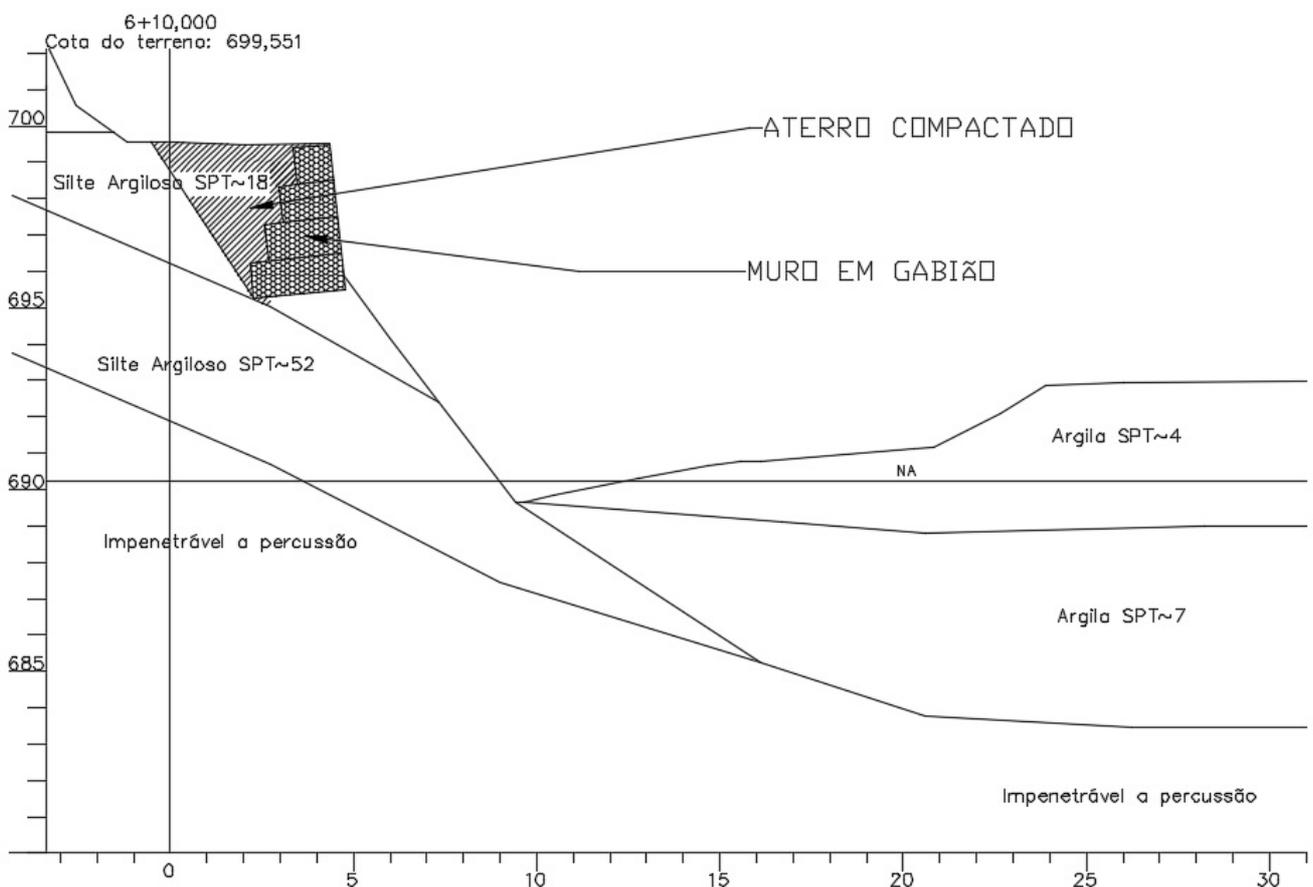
Contenção em Muro Gabião – Seção Tipo
